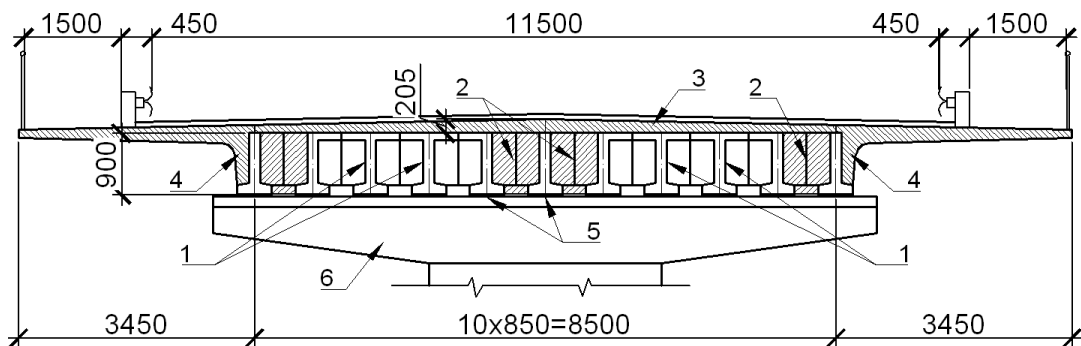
Поперечний переріз прогонової будови мосту із застосуванням накладної монолітної плити для збільшення габариту проїжджої частини: 1- існуючі балки, 2 – монолітні вставки підсилення балок, 3 – монолітна залізобетонна накладна плита з консолями, 4- обетонування фасадної поверхні крайньої балки, 5 – опорні частин балок, 6- ригель опори
